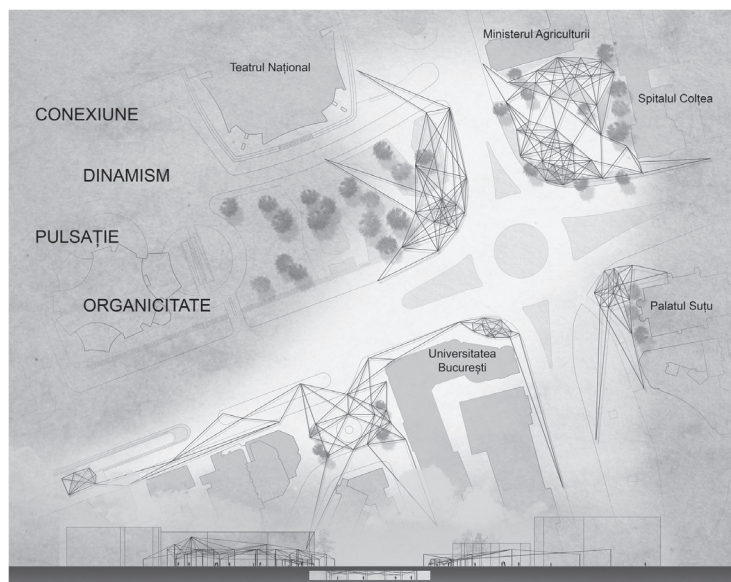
Plan de situație și secțiune prin pasaj / Site Plan and cross section through the underpass
